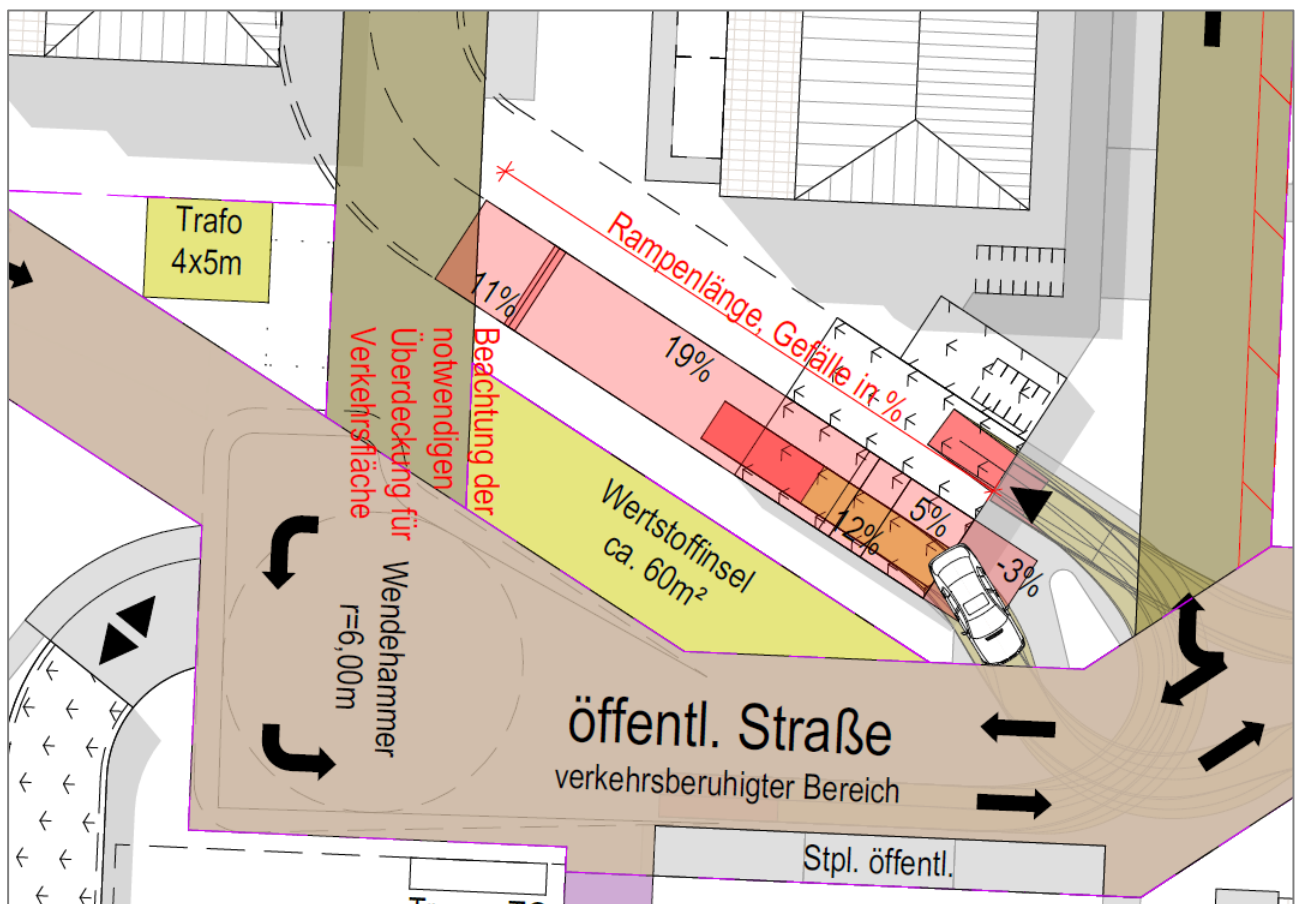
Tiefgaragenzufahrt im Plangebiet, Quelle: Planungsgruppe Strasser
